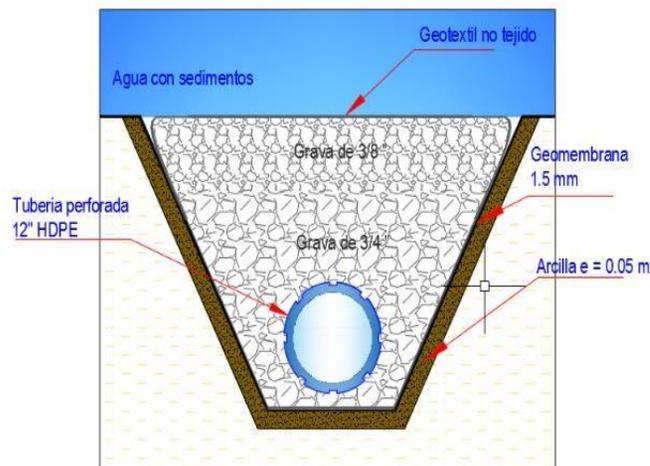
Subdrenaje al pie del dique tomado de la Segunda Modificación del Plan de cierre de Minas Unidad Minera Anabi, por Clean Technology (2018).
